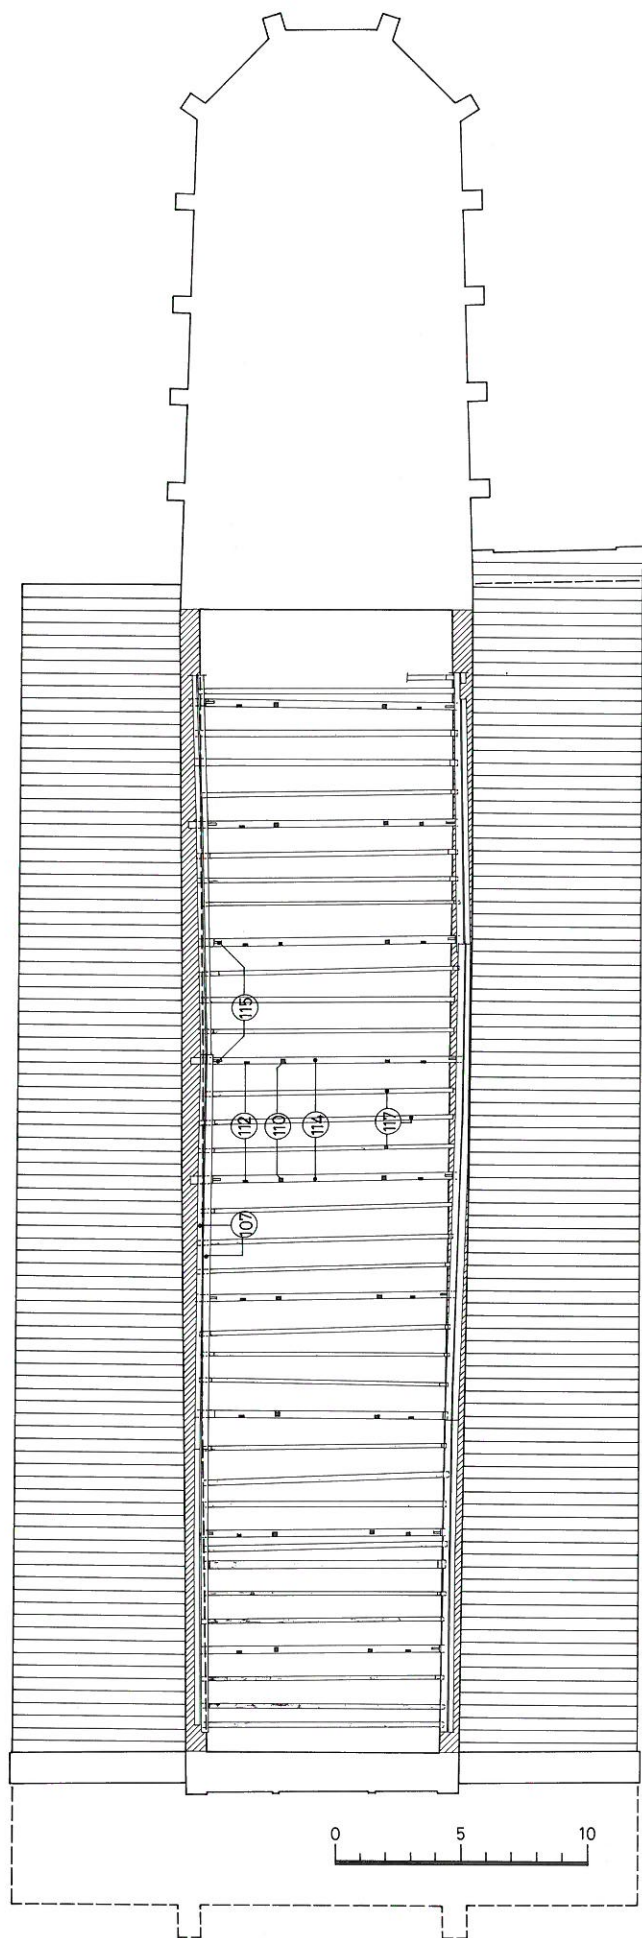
Grundriss des Mittelschiff-Dachgeschosses (Massstab 1:300).
